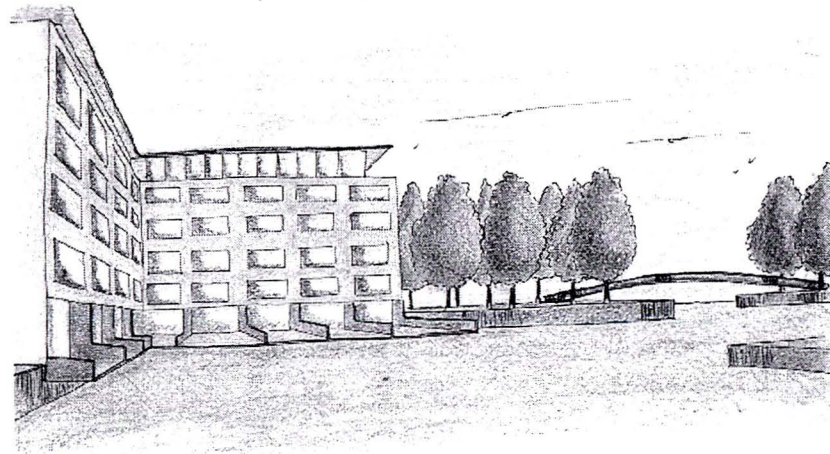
onder de bomen door uitzicht op IJburgbaai
